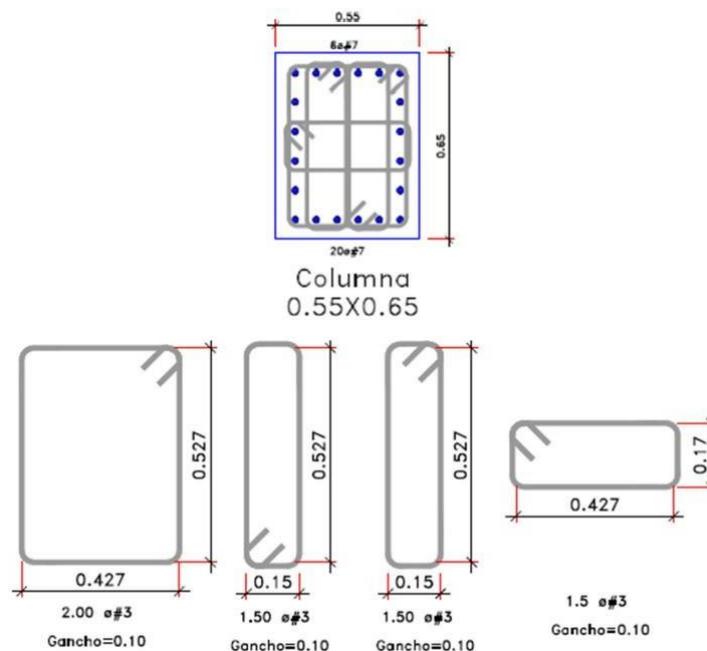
Vista De Planta De Secciones En Elevación Robot Structural 2022
